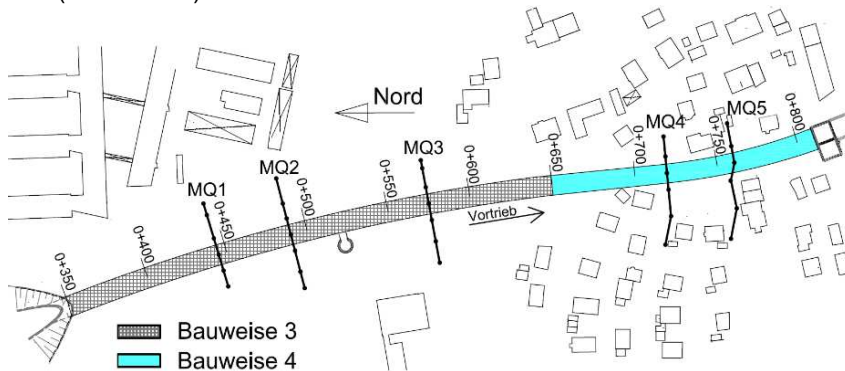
Lageplan mit Messquerschnitten und Eingrenzung der Bauweise 3 und 4
